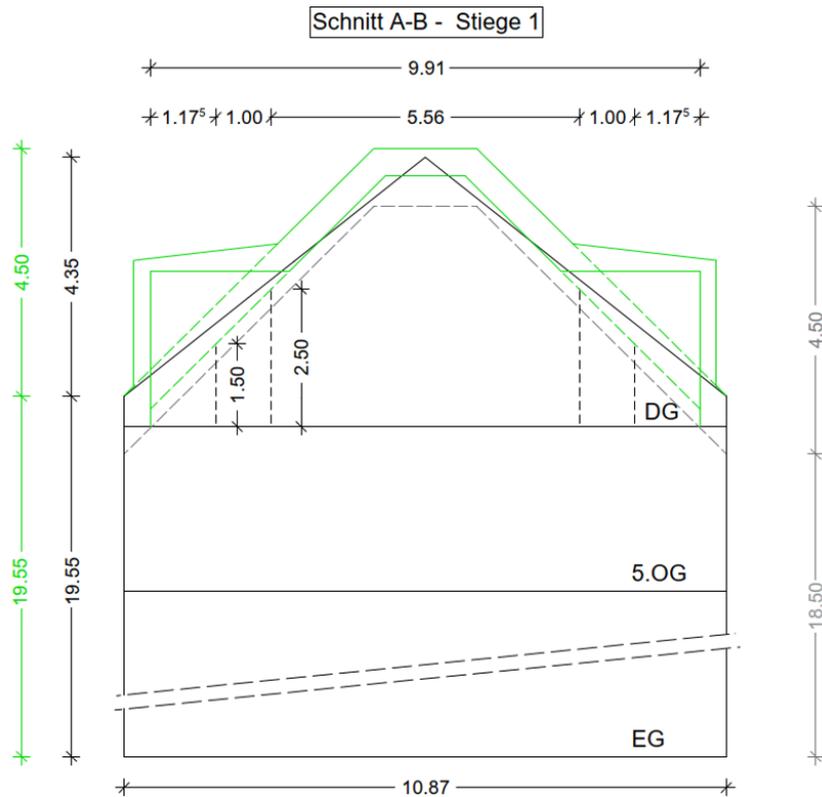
Ausstellungsstraße 67 - Schnitt Stiege 1
